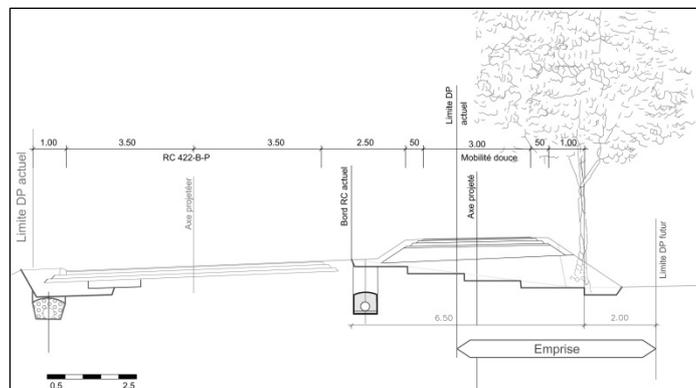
extrait plan de soumission, coupe type itinéraire de mobilité douce et RC 422 (coupe 1)
